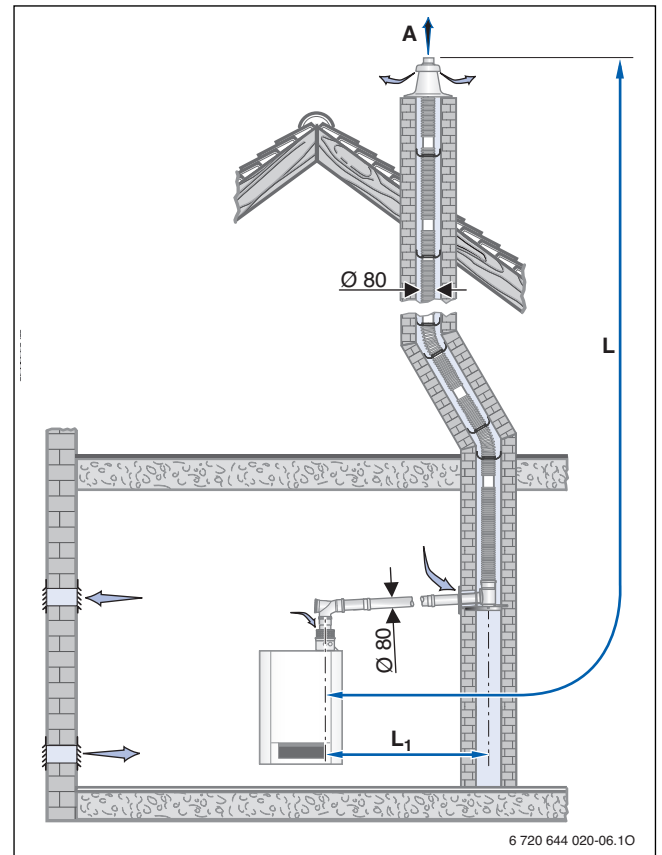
Montagevariante mit dem Bausatz GA + UB-flex
